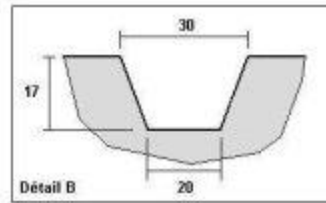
Panneaux à bossage Type 1 (dimensions en mm)
